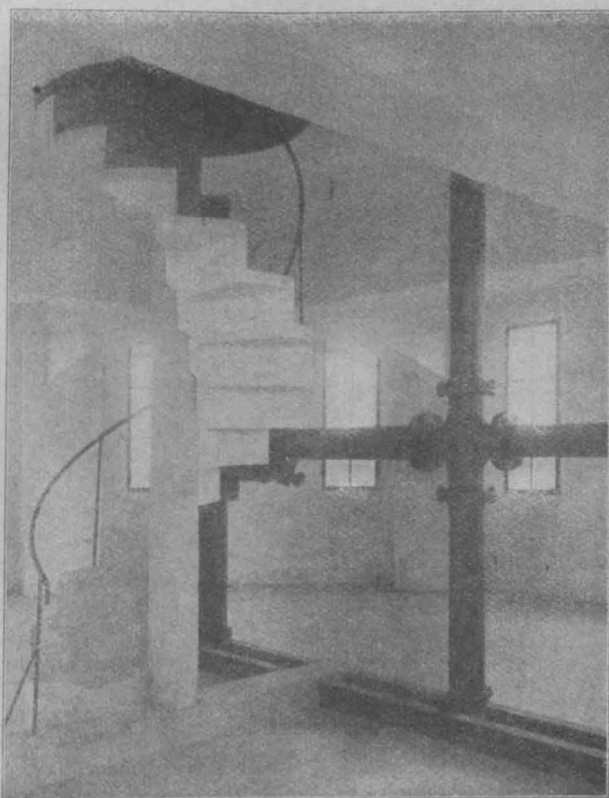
Eisenbeton-Wendeltreppe durch den zentralen Schacht des Wasserbehälters.
